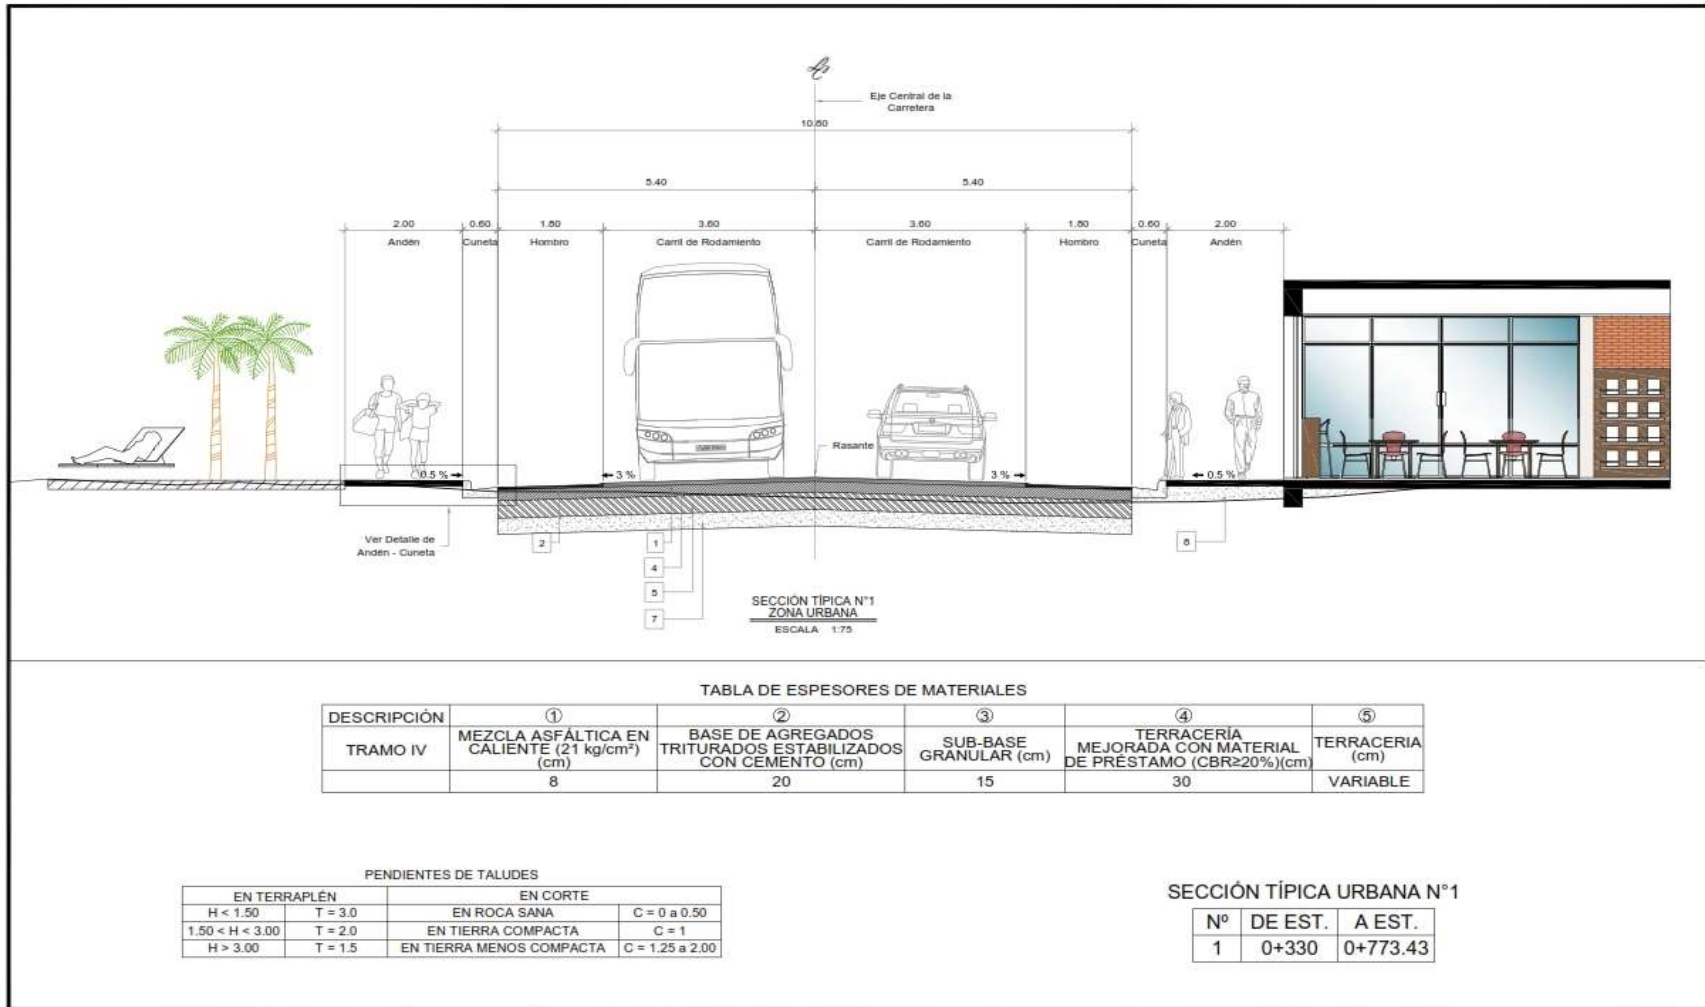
Propuesta de Sección Típica Transversal Zona Urbana N°1
